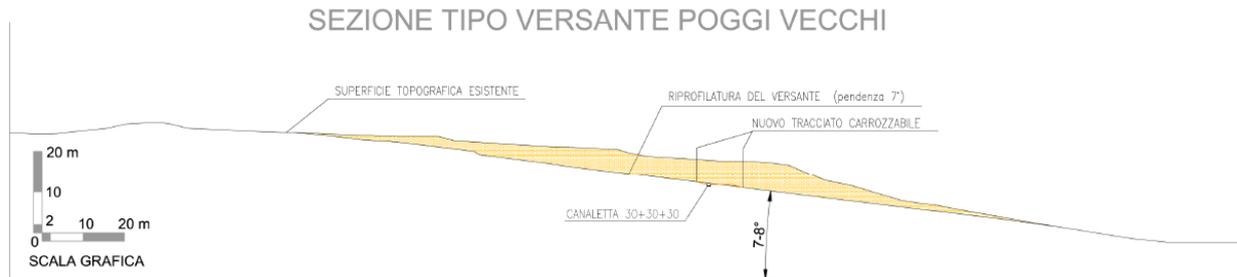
MA11 –Poggi Vecchi: Sezione tipo del versante oggetto di intervento.
